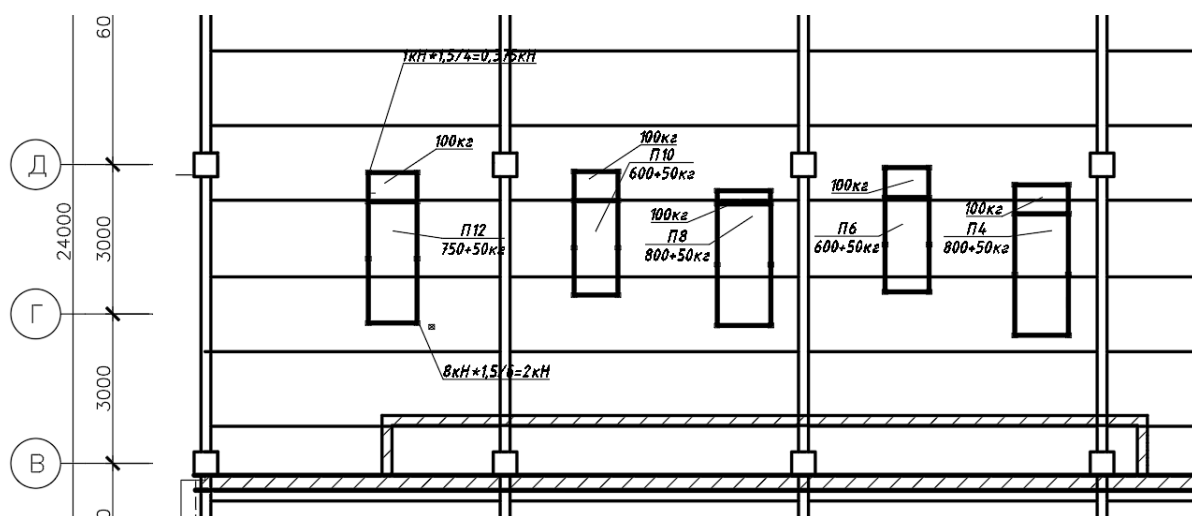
Схема добавляемых нагрузок на существующее оборудование при новом оборудовании в осях 9-13(на схеме не указаны фундаменты Ф)
